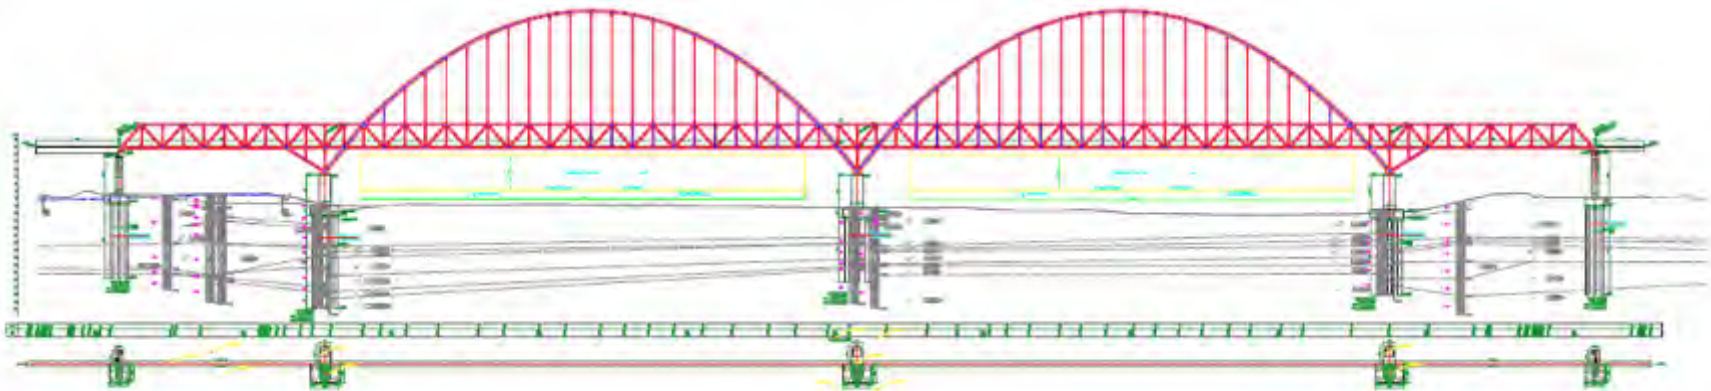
洪奇沥水道特大桥部分桥段立面布置图
